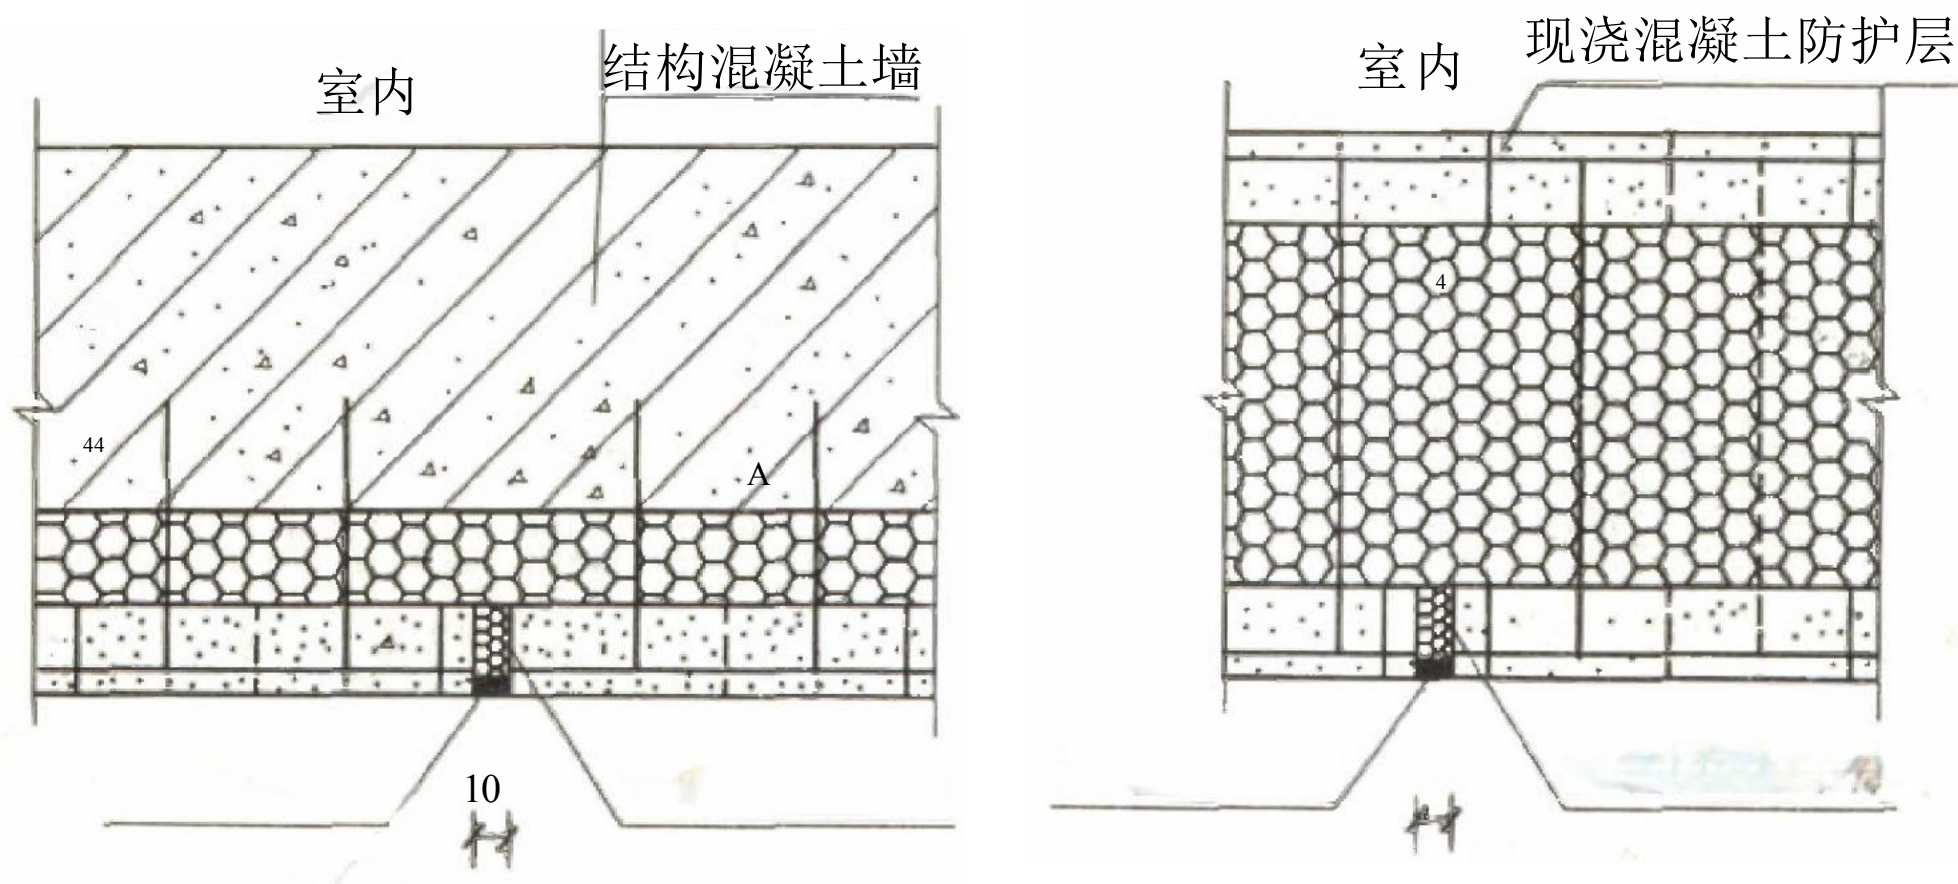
外层混凝土分隔缝构造示意图 (单位: mm)
